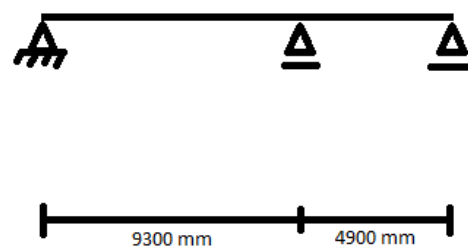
Bjelkesystem i plan 7. Dimensjonert bjelke er markert med rød pil.
